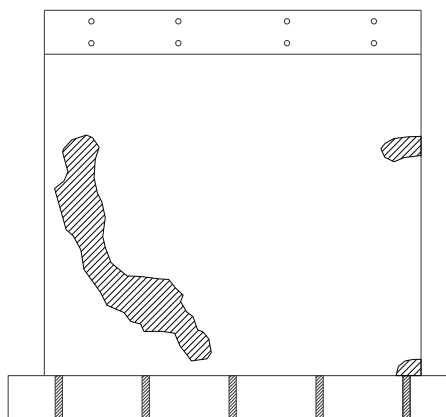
Reparación tipo I en muro de albañilería confinada con ladrillos sólido artesanal en la distorsión 1/2150.
